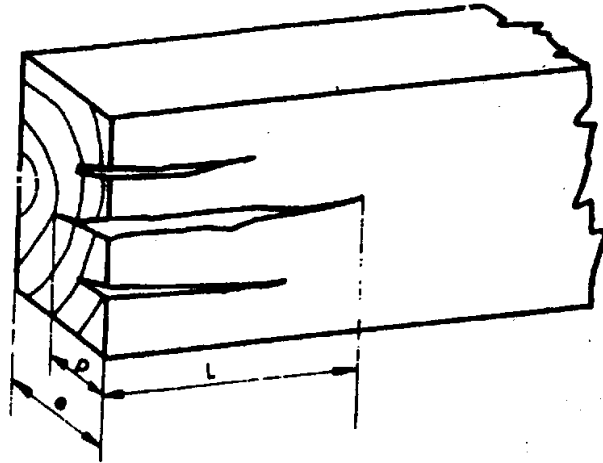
Grietas producidas durante el secado de la madera.
